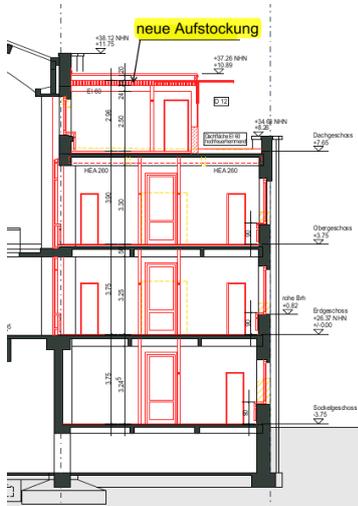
Aufstockung Dachgeschoss [Triade Architekten]
